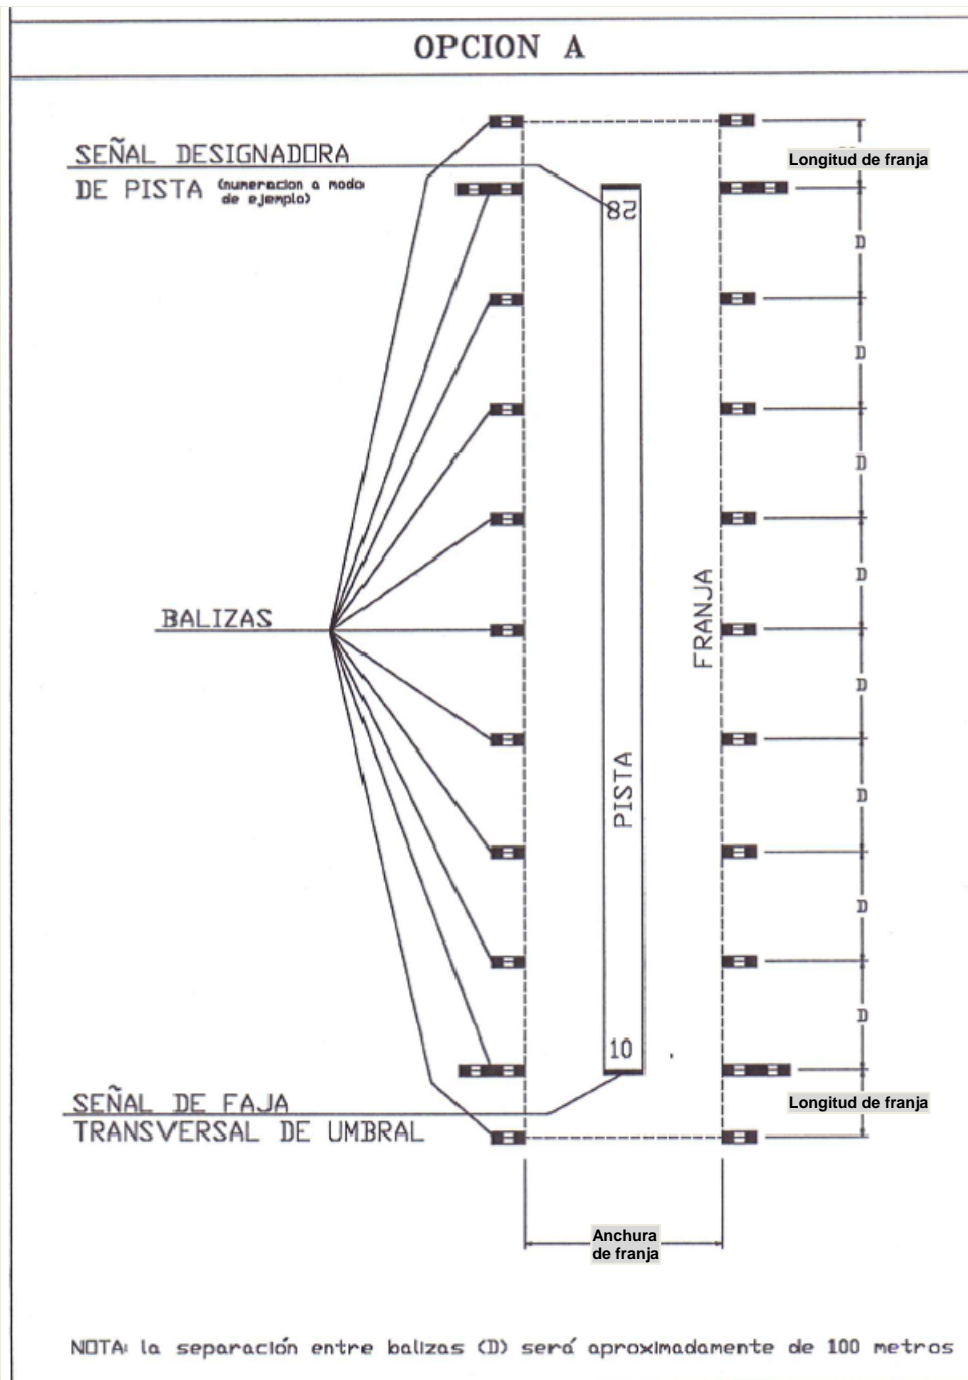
Señalización de pistas no pavimentadas con umbral desplazado
